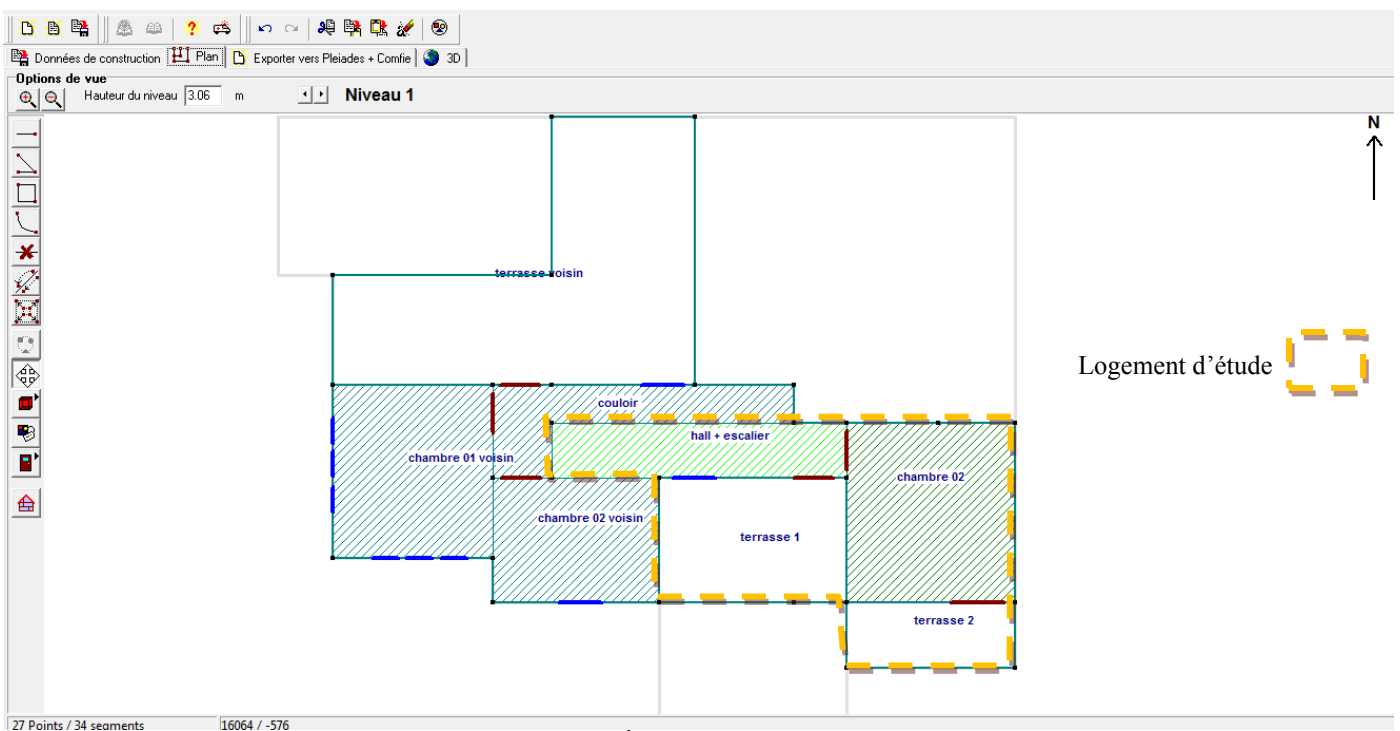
Plan de 1^{er} Étage dessiné par ALCYONE
